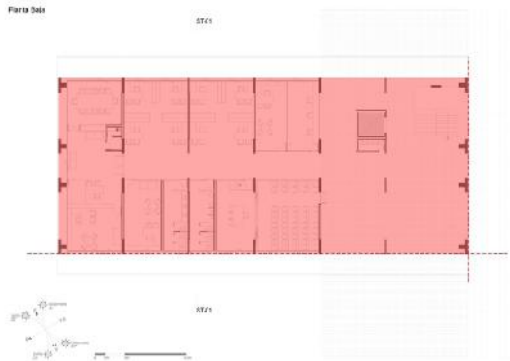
Planta - Emplazamiento Aulario Universidad de Cuenca. Esquema propia autoría.
